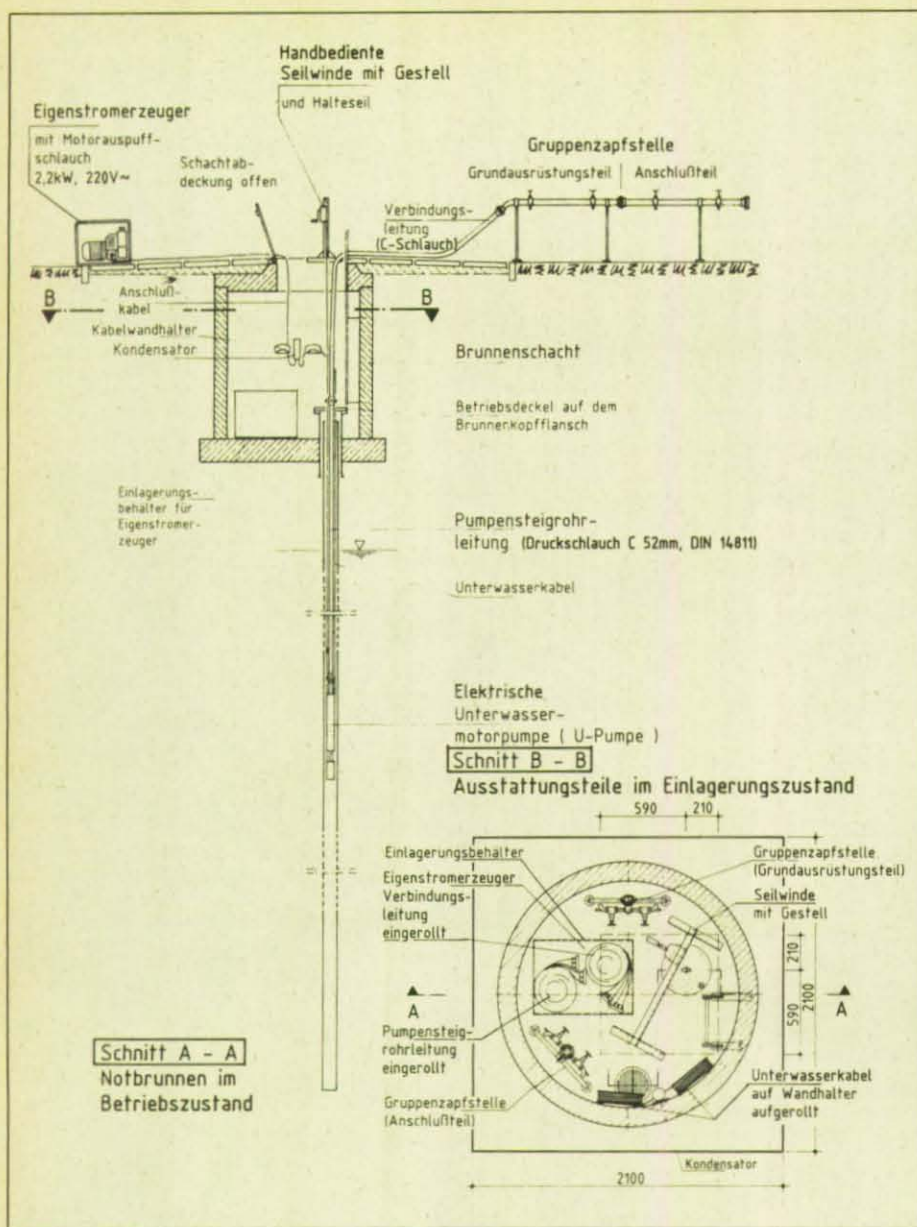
Trinkwasser-Notbrunnen, ausgerüstet mit einer vom öffentlichen Stromnetz unabhängigen elektrischen Unterwassermotorpumpe und im Brunnenschacht eingelagerten Ausstattungsteilen, wie transportabler Eigenstromerzeuger, Druckschläuche zur Trinkwasserförderung, Unterwasserkabel, Handseilwinde mit Gestell, Gruppenzapfstelle zur Wasserverteilung an die notzuversorgende Bevölkerung (Schnittzeichnungen).
